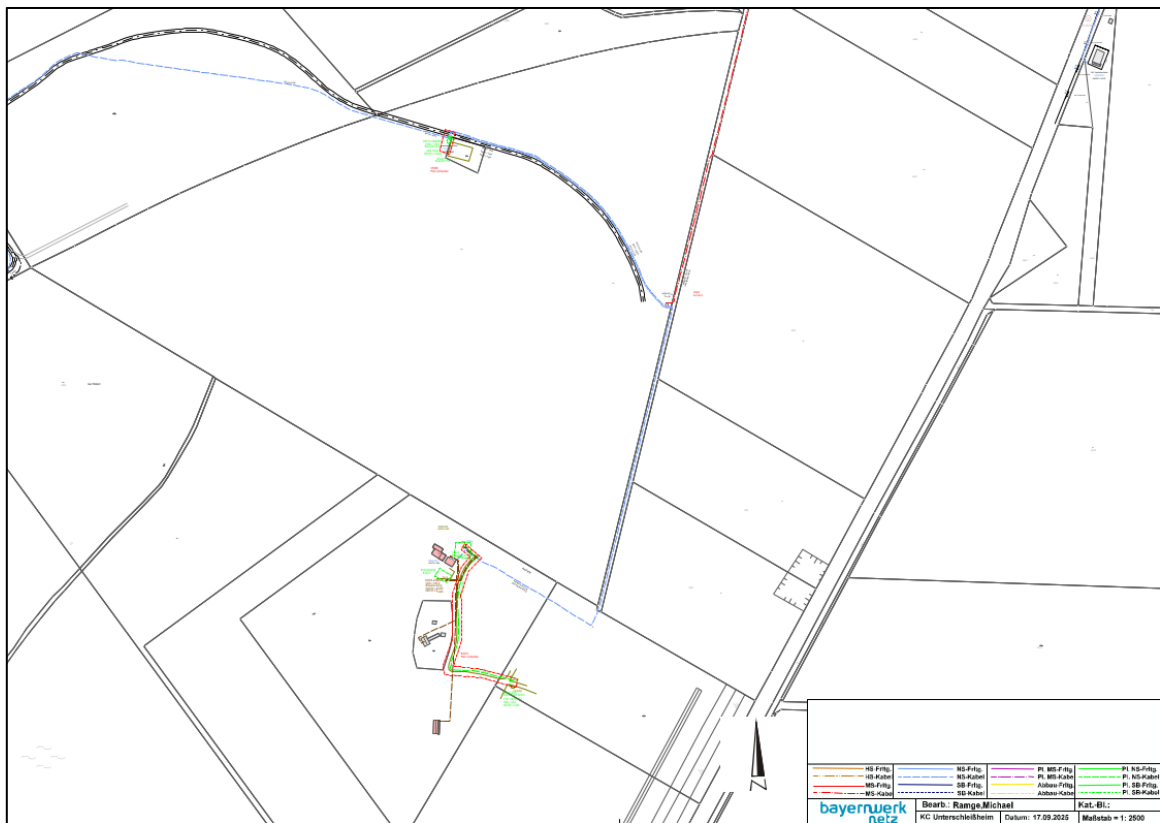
Lageplan mit Verlauf der Leitungen „BBP\_28B\_Hollerner\_See\_Lageplan2“ der Bayernwerk netz GmbH, übermittelt am 18.09.2025
